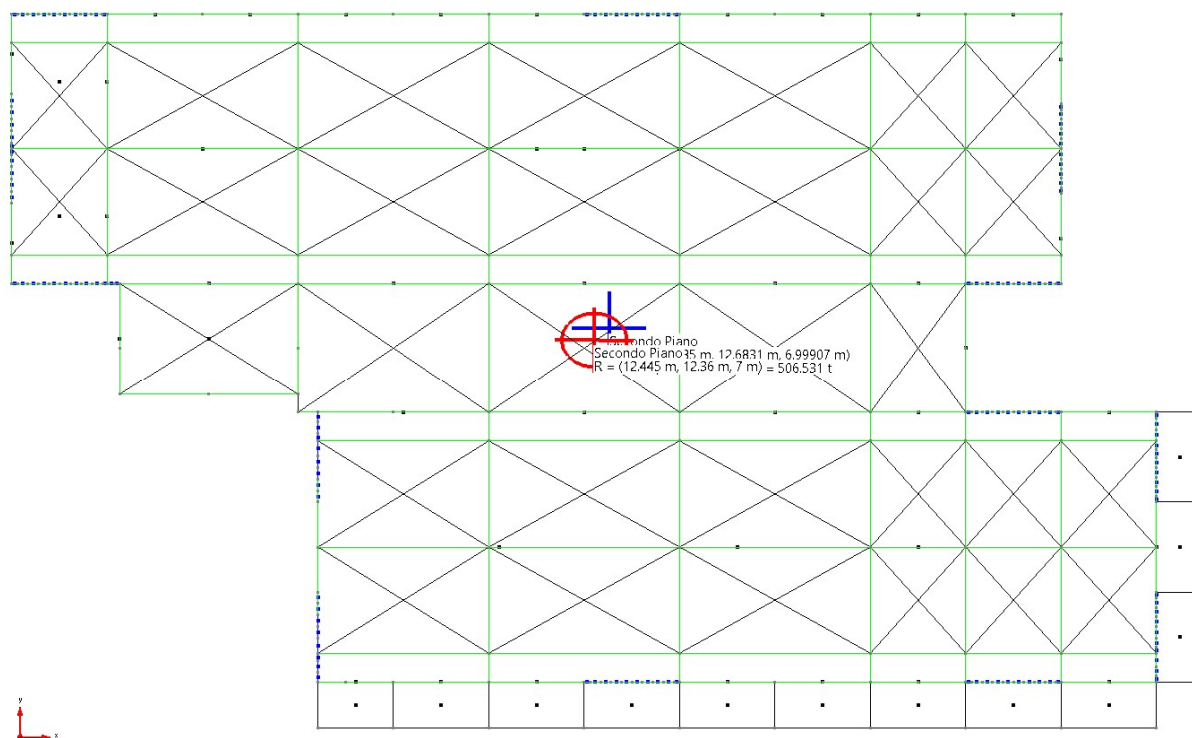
Stato di Progetto : posizione del baricentro delle masse G e delle rigidezze R al secondo impalcato.
